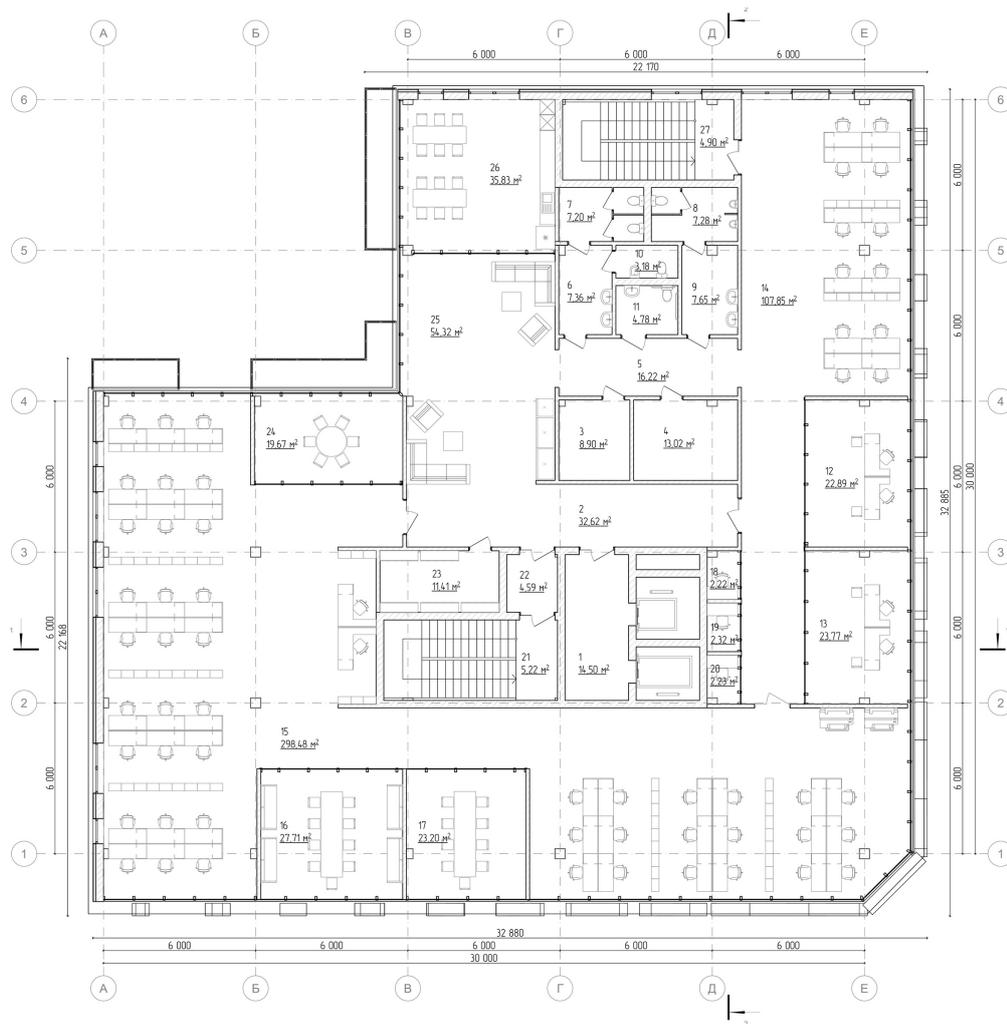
Розташування колон офісної будівлі на плані першого поверху
